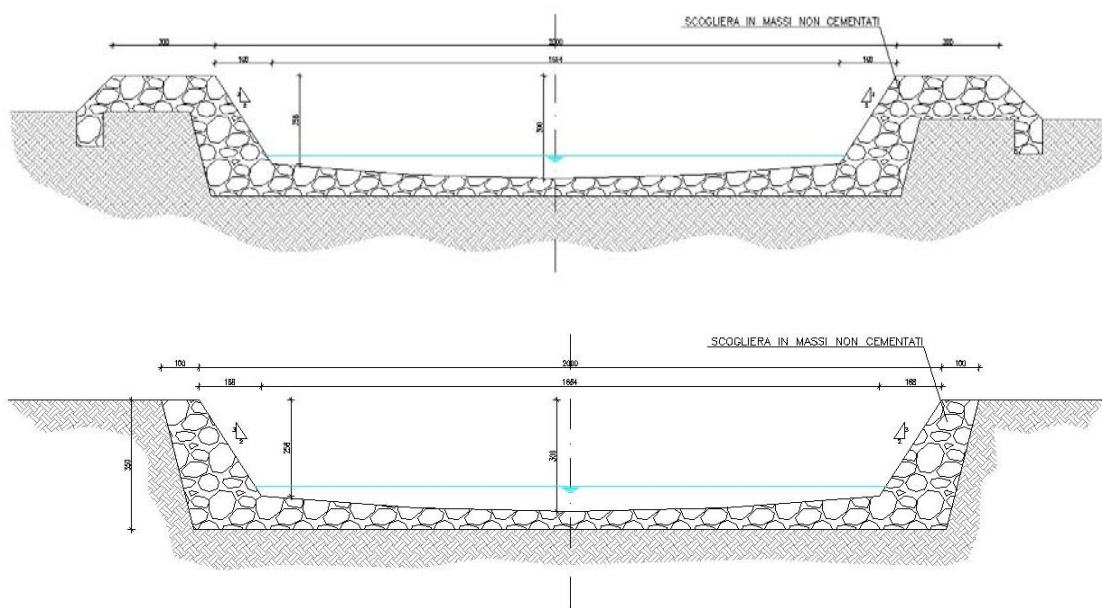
Sezioni tipo del tratto finale (a valle della SS 33 del Sempione)
